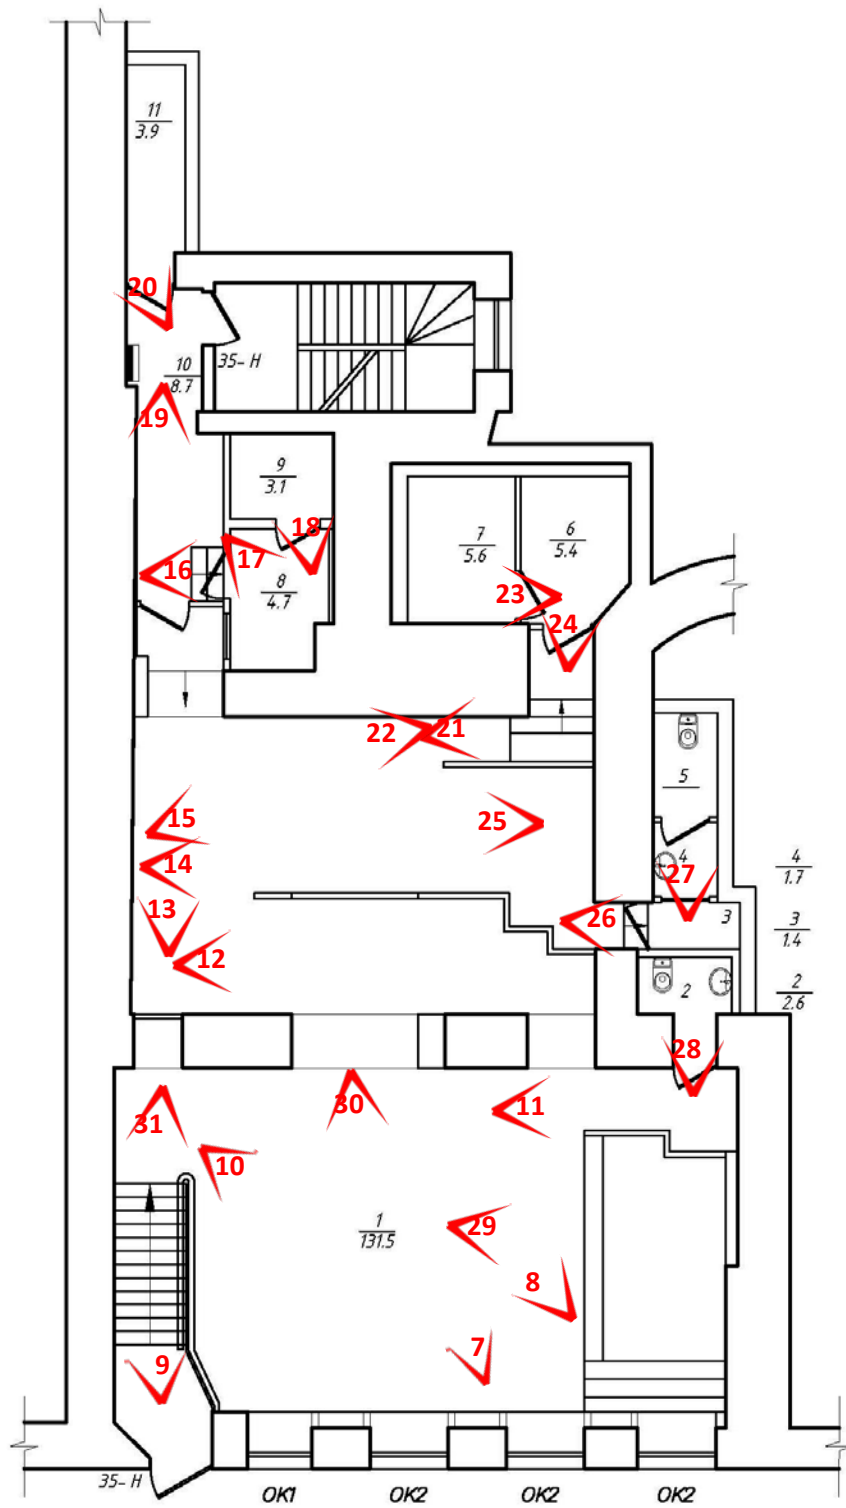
Схема фотофиксации на фрагменте плана 1 этажа
